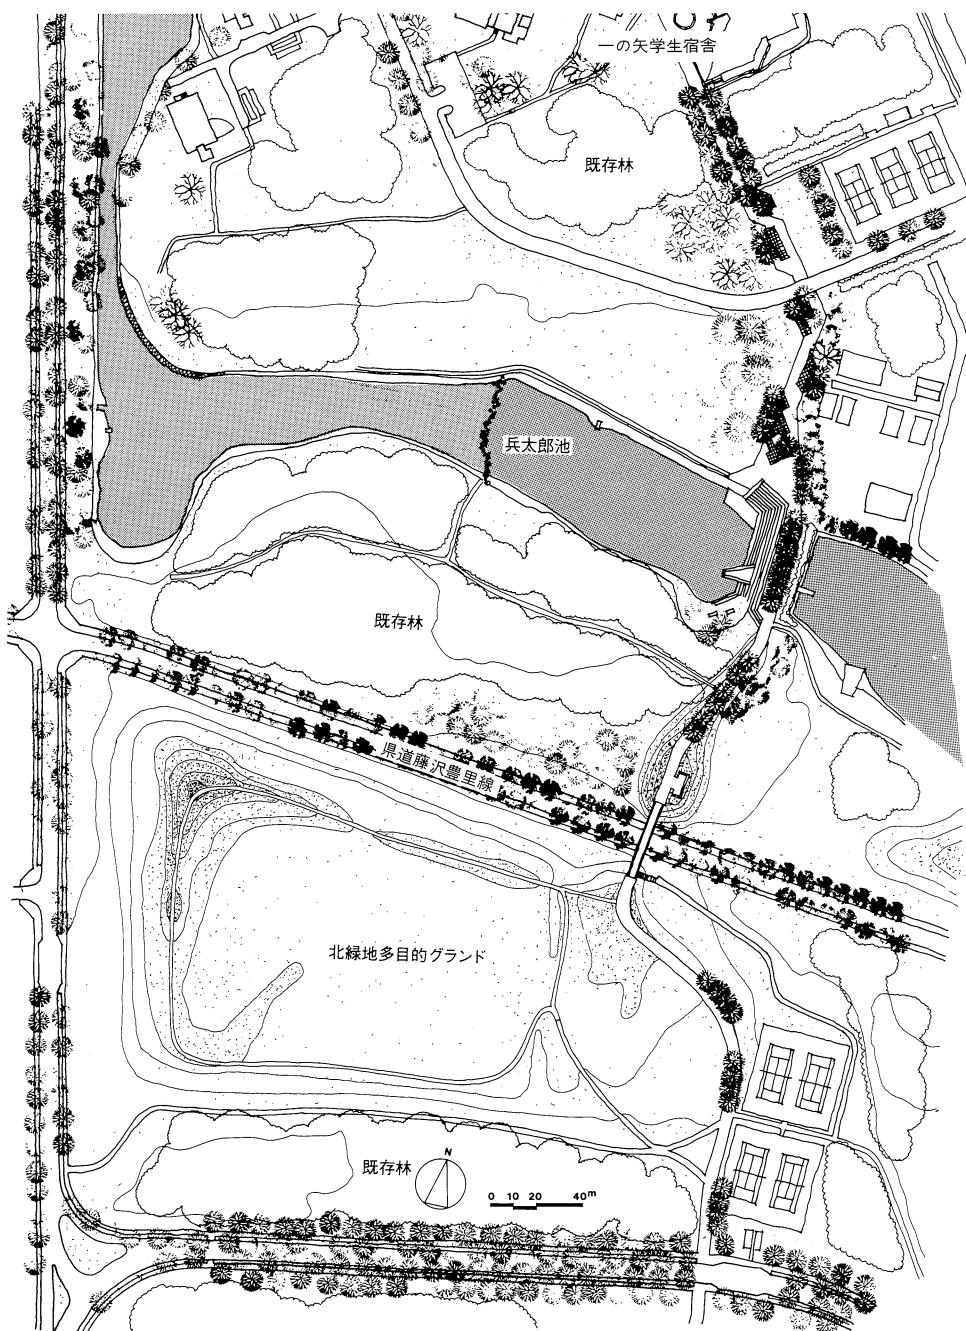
北緑地・兵太郎緑地平面図
